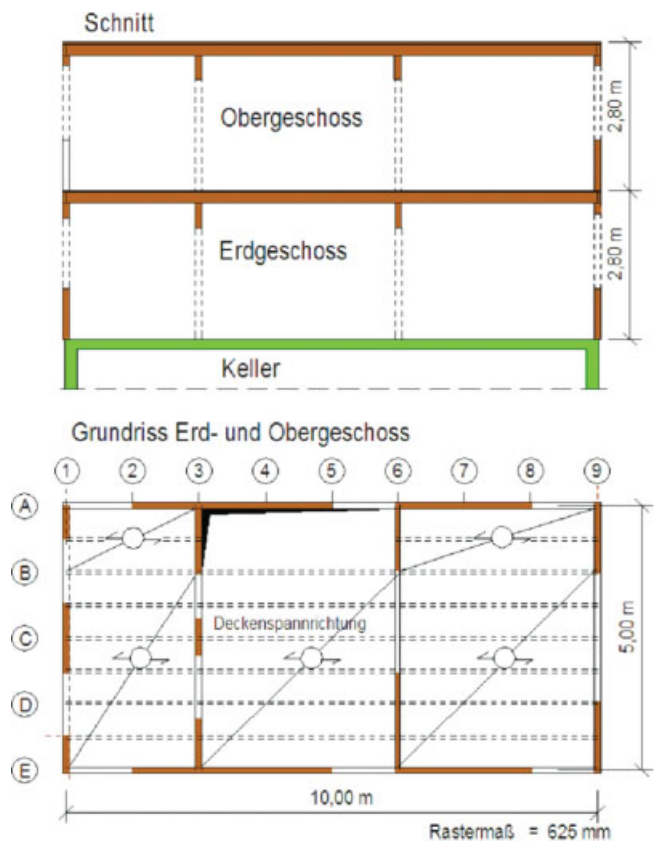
Schnitt und Grundrisse eines zweigeschossigen Wohnhauses
